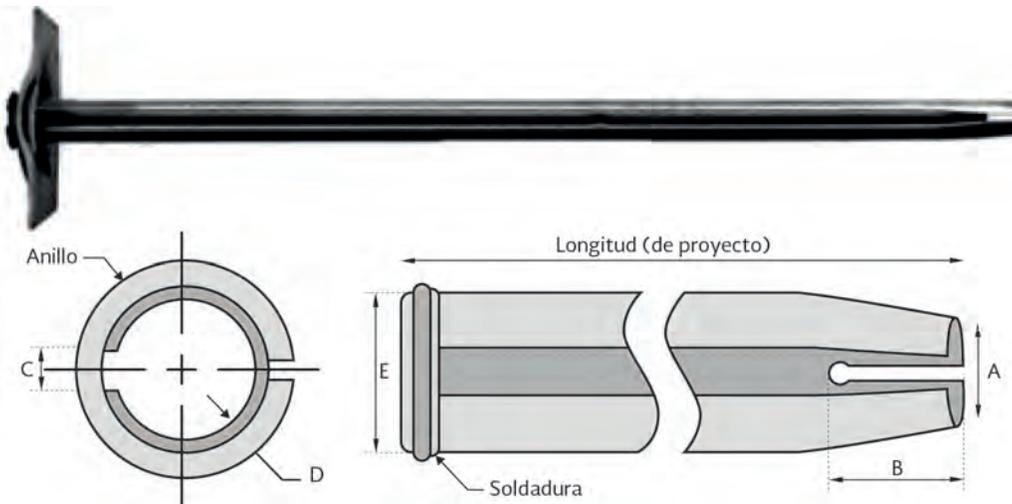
Anclajes o estabilizadores de fricción tipo Split-Set. Tomado de Shandong Tongrui Mining Technology Co., LTD.
